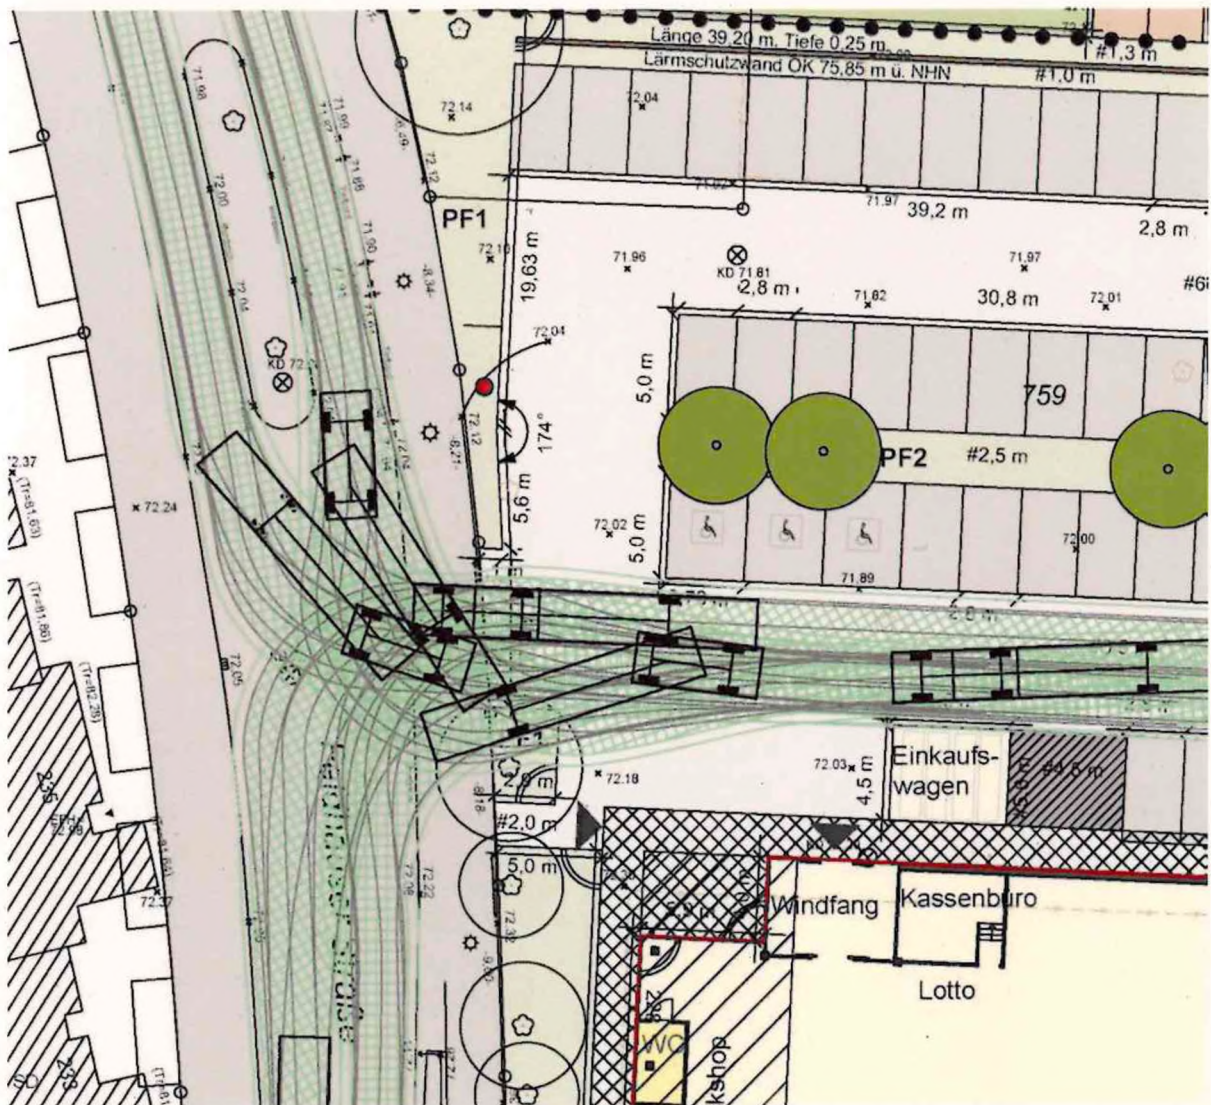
Planausschnitt Befahrbarkeitsuntersuchung Zufahrt Einzelhandel
